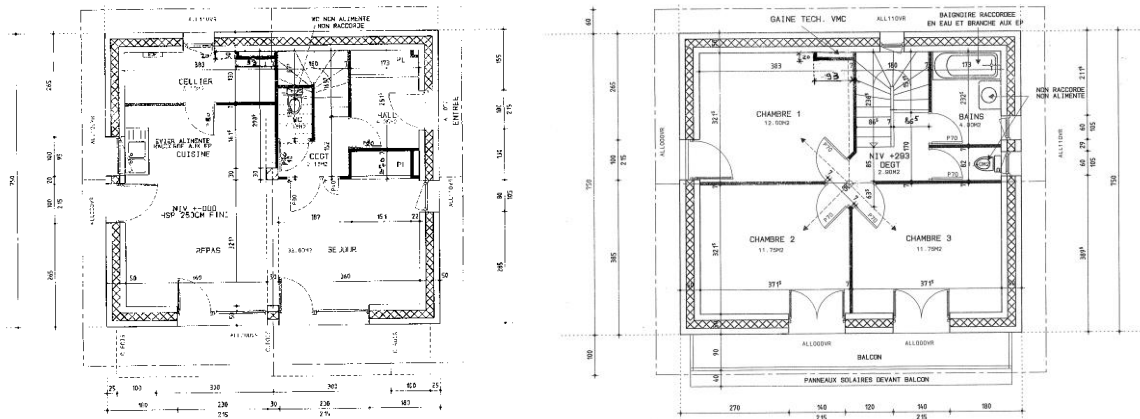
Plans de la Maison I-DM (RDC à gauche, 1<sup>er</sup> étage à droite)
